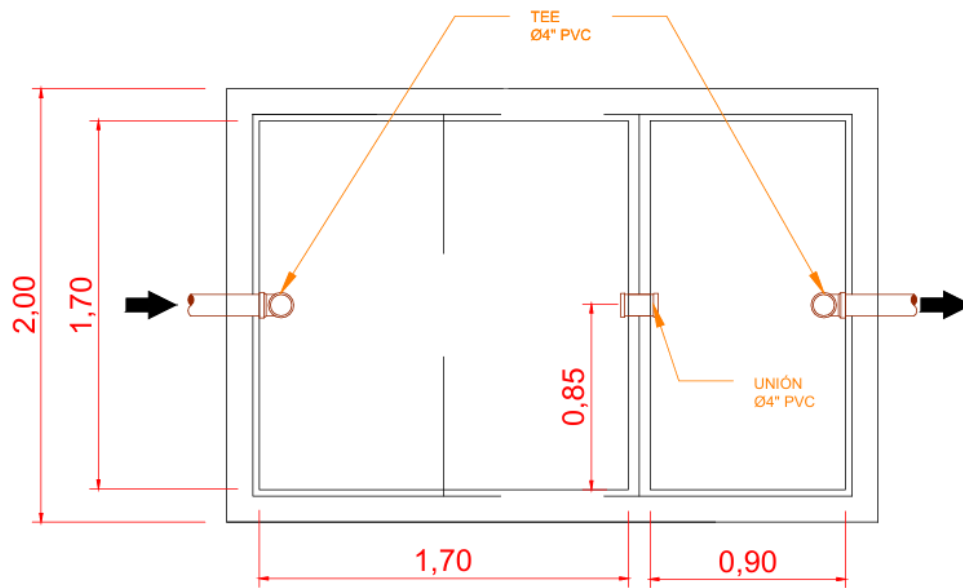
Vista en Planta de Tanque Séptico. Escala 1:150.
